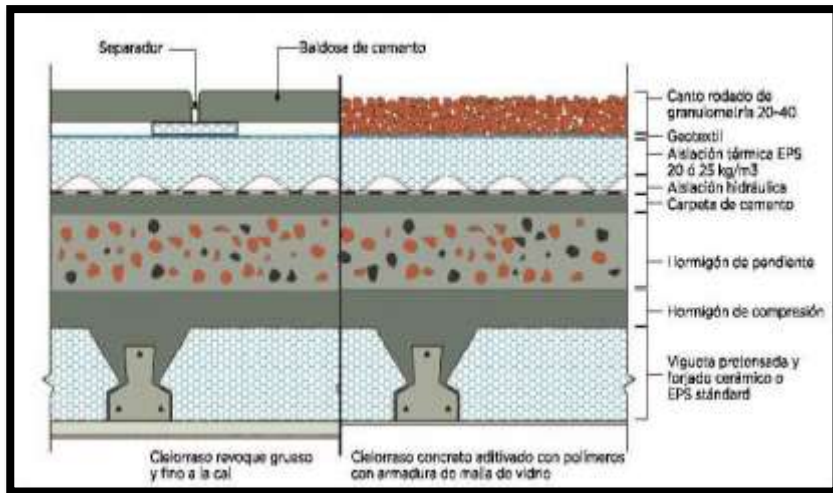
Detalle de una Losa de Cubierta Plana
